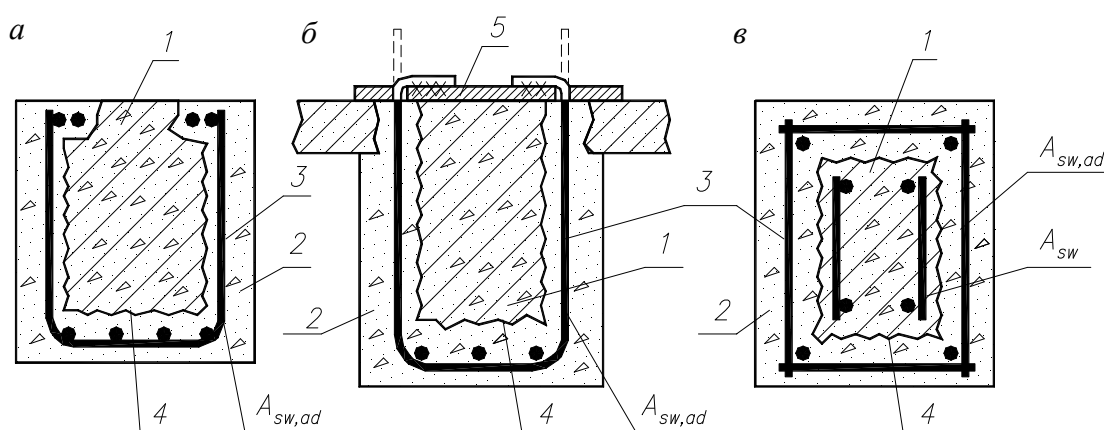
Усиление зоны среза конструкций увеличением поперечного сечения: а – рубашкой при прямоугольном сечении; б – рубашкой при тавровом сечении; в – обоймой, 1 – усиливаемая конструкция, 2 – монолитный бетон, 3 – дополнительная поперечная арматура, 4 – насечка поверхности, 5 – анкерная пластина
